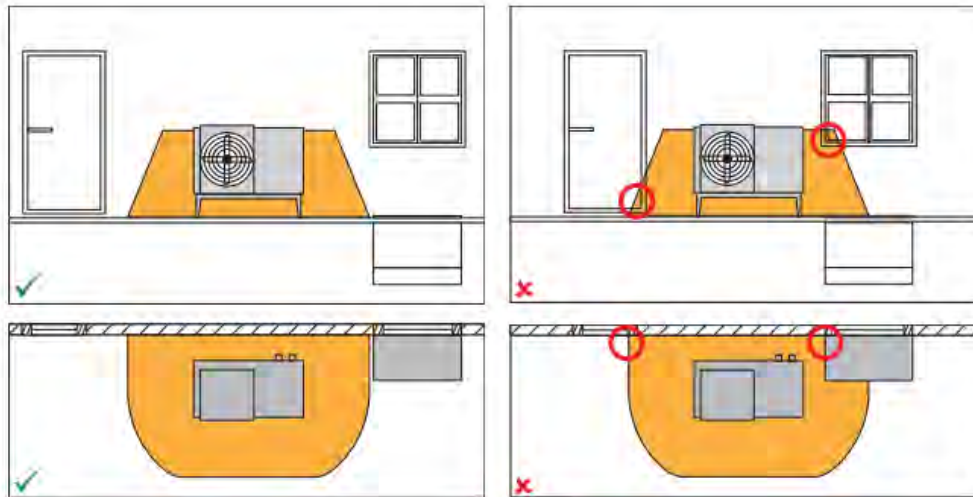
Bereich bei Installation an einer geschlossenen Wand. Quelle: BWP-Leitfaden.
